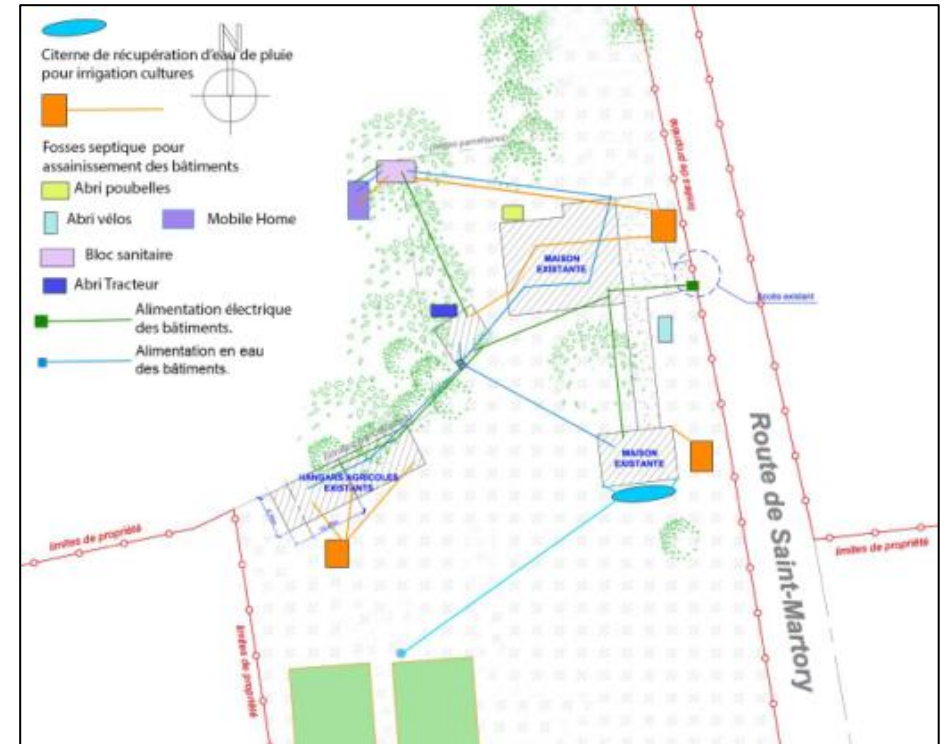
Plan des installations avec tracé des réseaux existants (source : dossier projet).
